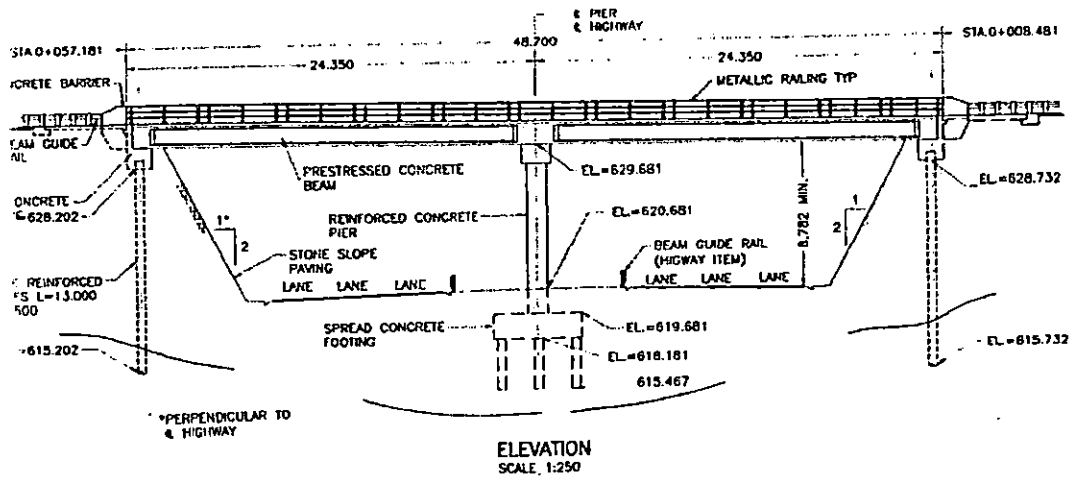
ELEVACION DEL PUENTE.
